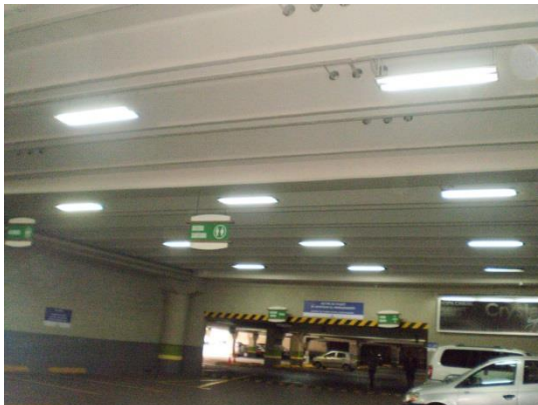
Losa de sección doble T pretensada, parqueadero centro comercial KIWI.
